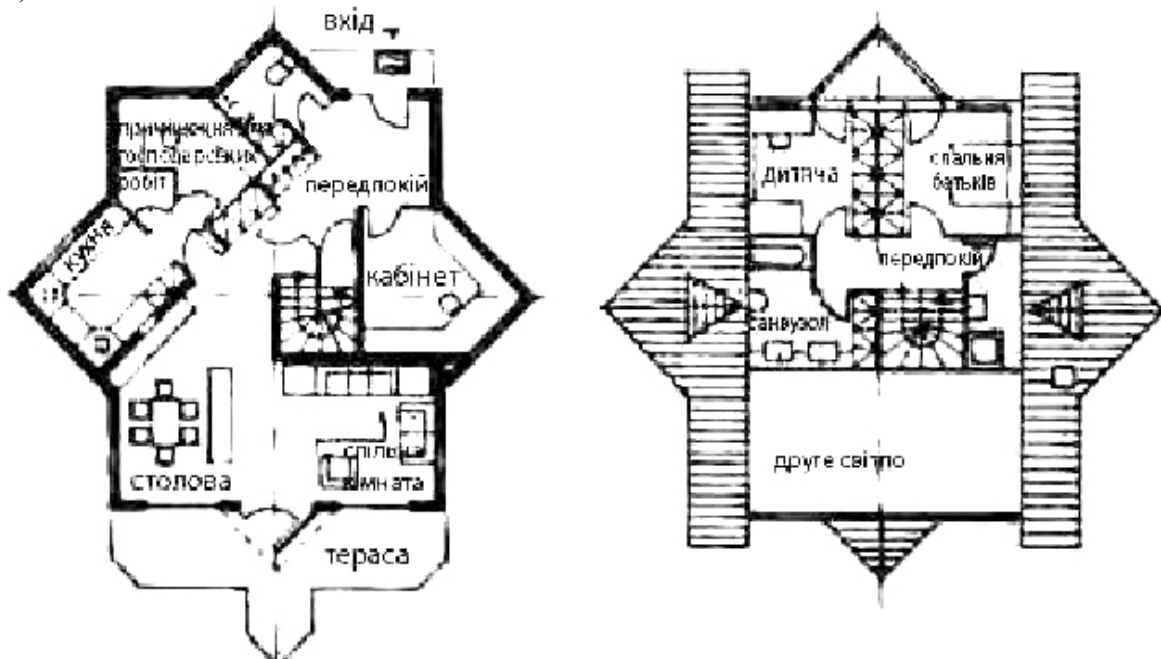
Приклад оптимальної моделі комфорту. План першого та другого поверхів.
